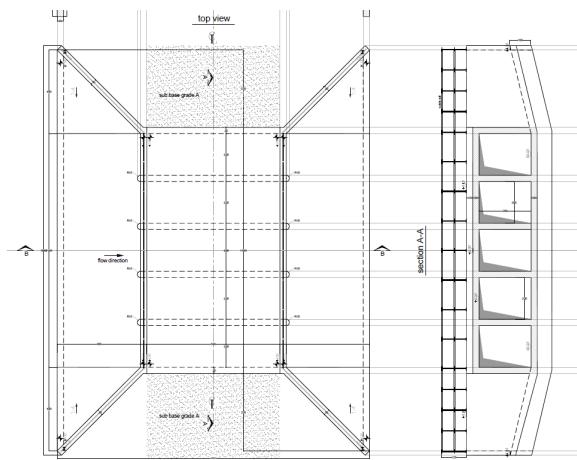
Vista del alcantarillado que se desea construir sobre la Quebrada Pesé
